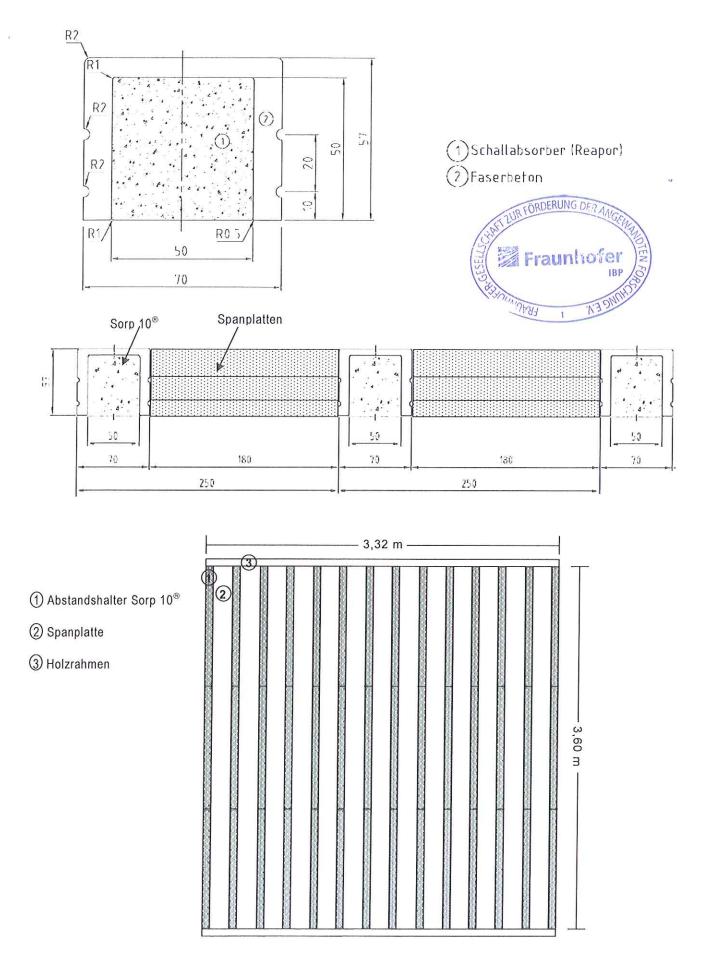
Detailzeichnungen (Schnitt durch einen Abstandshalter Schnitt durch den Prüfaufbau) sowie Ansicht des Prüfaufbaus im Hallraum; (Prüfobjekt S 10415-02; Maße in Millimeter (mm)).
